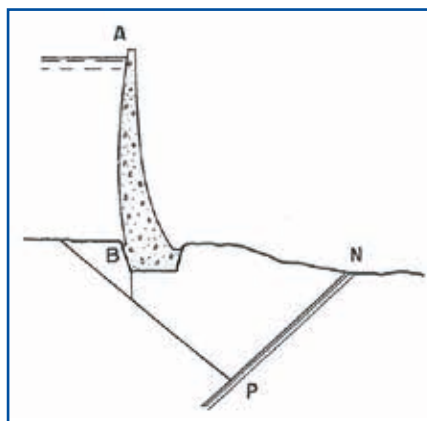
Barrage de Malpasset, coupe schématique du barrage et du sous-sol sur la rive gauche.
